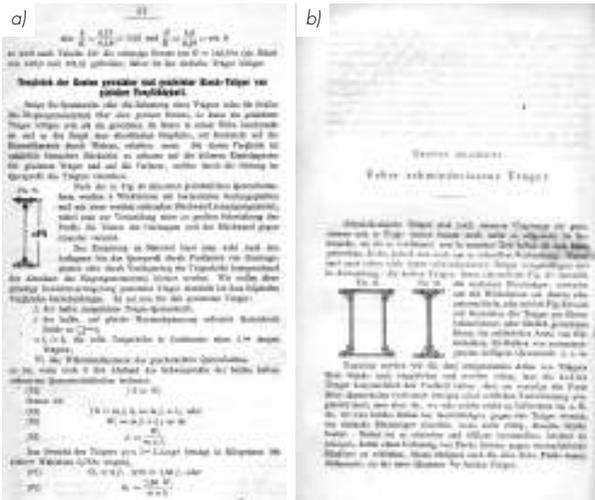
Las vigas típicas en los libros de a) William Fairbairn, *Die eisernen Träger und ihre Anwendung beim Hochbau und Brückenbau*, trad. al alemán por D. Brauns, Braunschweig, 1859, y b) Otto Intze, *Tabellen und Beispiele für eine rationelle Verwendung des Eisens...*, Berlín, 1878.
